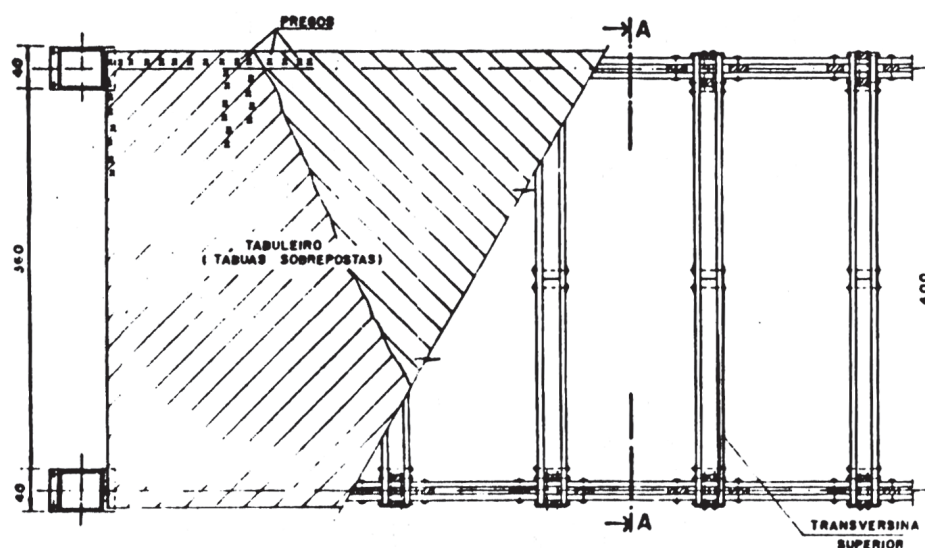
Detalhes do tabuleiro contraventado do projeto da estrutura da Passarela Pênsil de Piracicaba: vista em planta (Fonte: Calil Junior *et al.* 1993)
